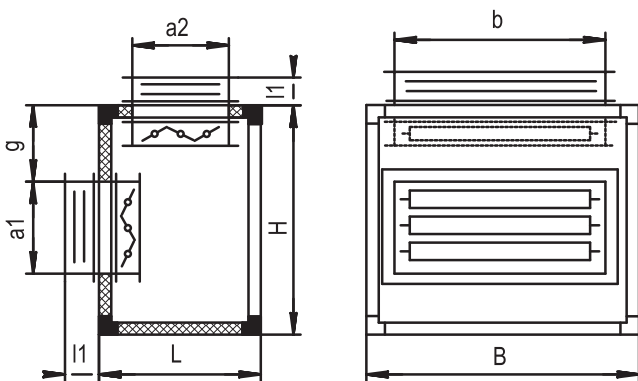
Блок приемно-смесительный с двумя клапанами внутри
